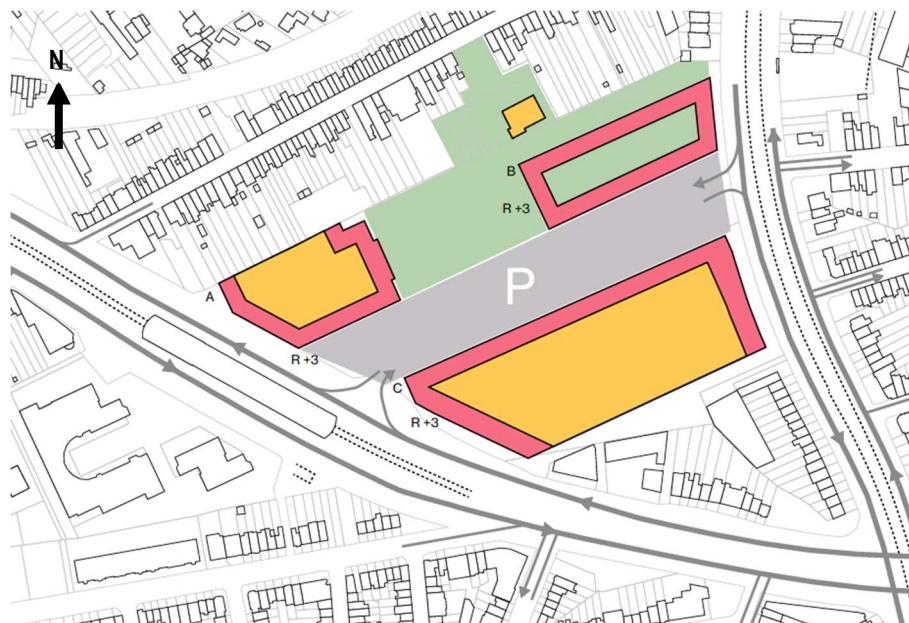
Implantations prévues sur le site Demey (ORG², 2018)
